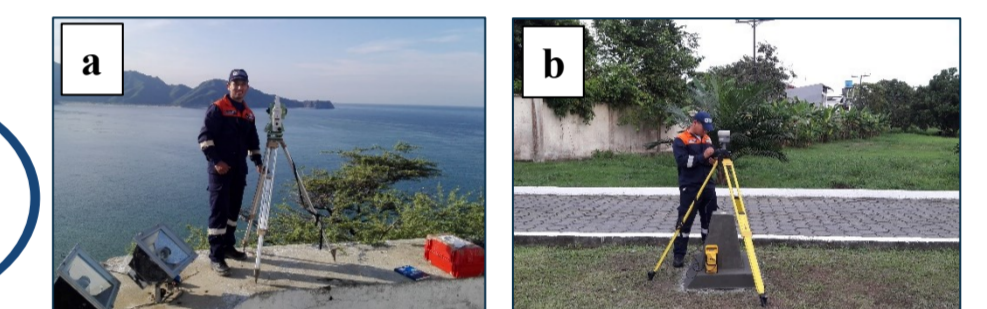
(a) Construcciones de vértices tipo inercustación en Santa Marta (b) Construcciones de vértices tipo pilastro en Tumaco
